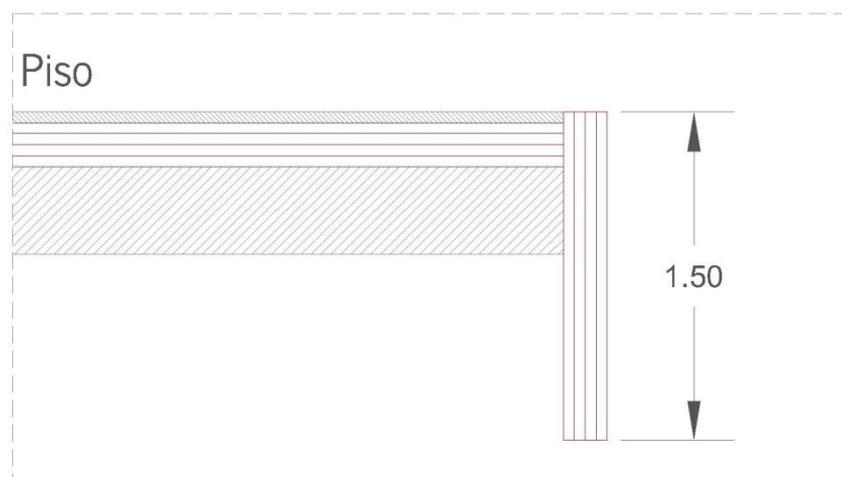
Colocação da Viga de MLCC abaixo da Laje Estrutural
